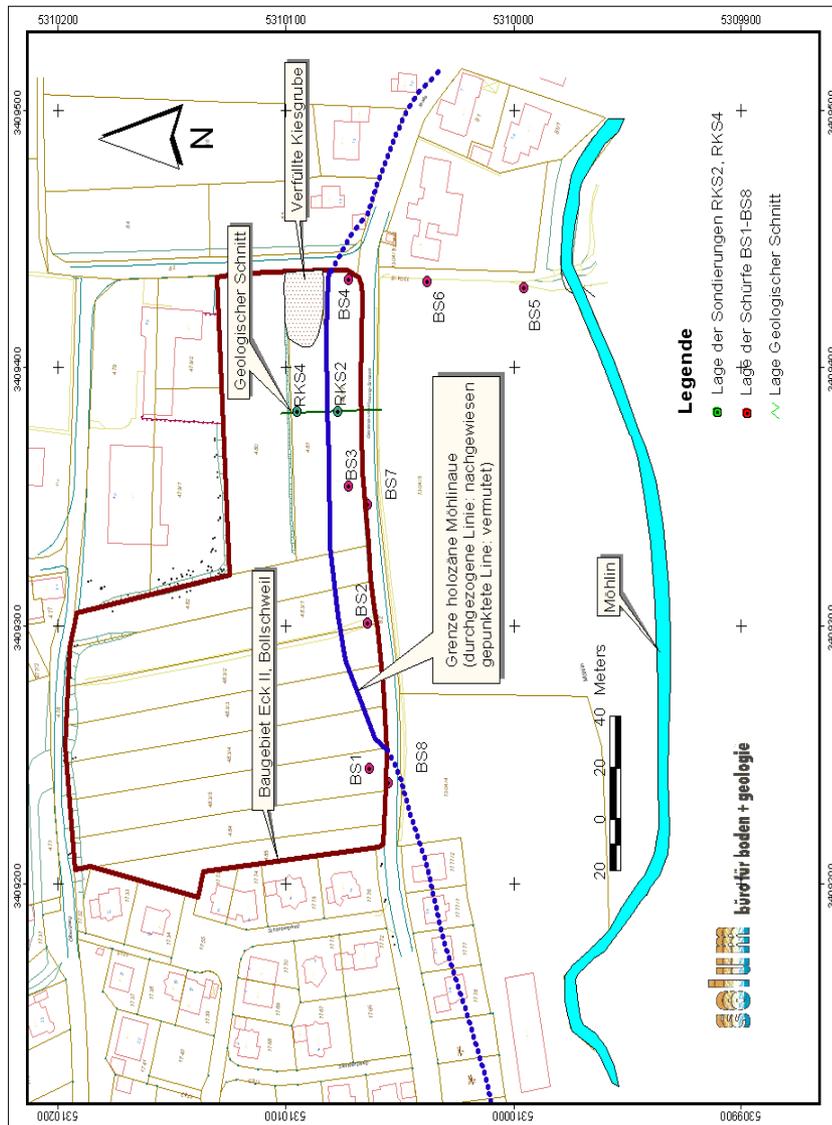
Lageplan Baugebiet Eck II, Bollschweil mit Position Schnitt, Schürfgaben und Sondierungen.
